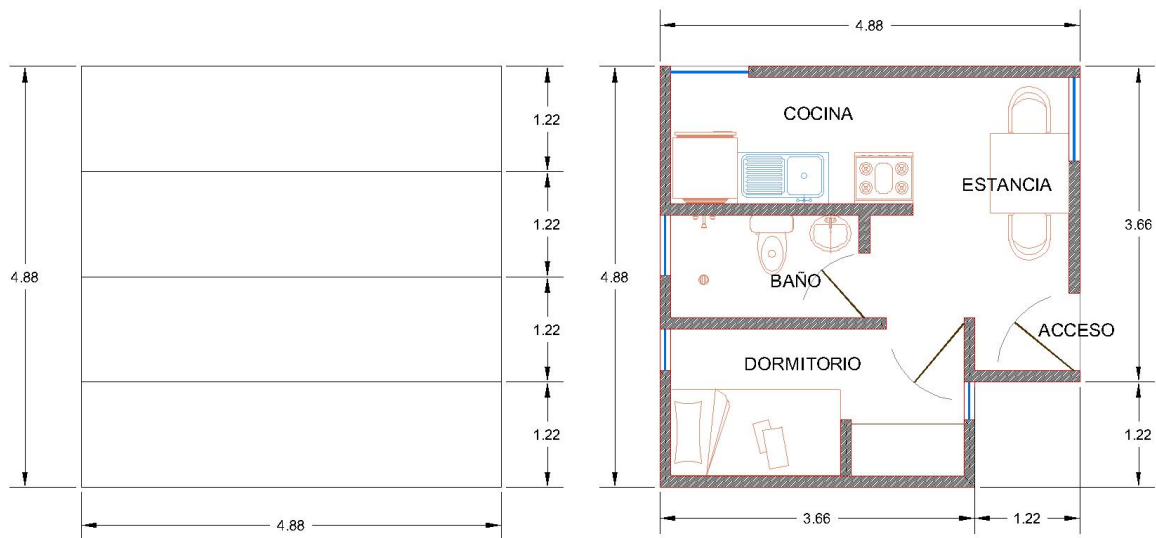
Repetición de módulo tipo “A” e implementación en Planta Arquitectónica de vivienda básica (esquema elaborado por el autor)
